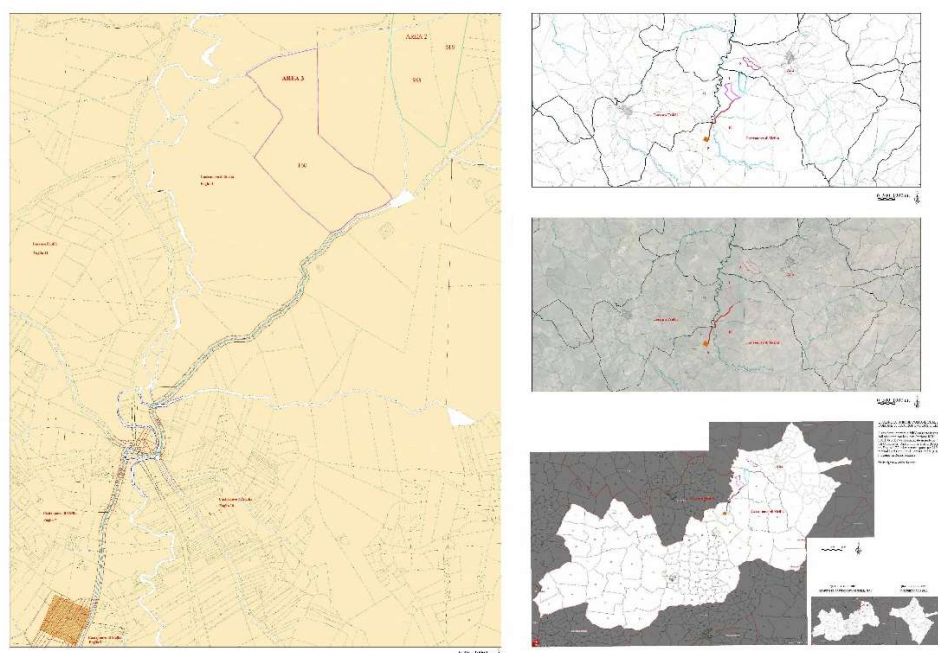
Cavidotto di connessione 380/150/36 KV con la stazione RTN
